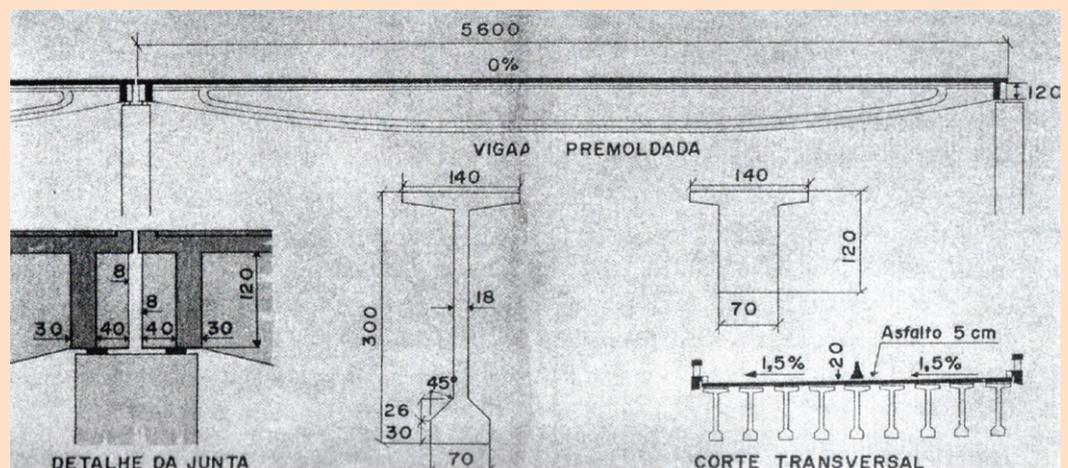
A MAIOR DAS VIGAS "BARRIGA DE PEIXE", LONGARINA TIPO C, CRIAÇÃO DO ENGENHEIRO NORONHA FILHO [10]
